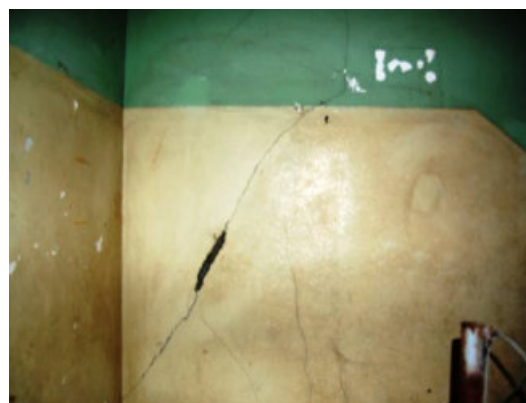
Fissuração em parede de alvenaria: escadas de acesso ao piso 2 do Corpo A.
